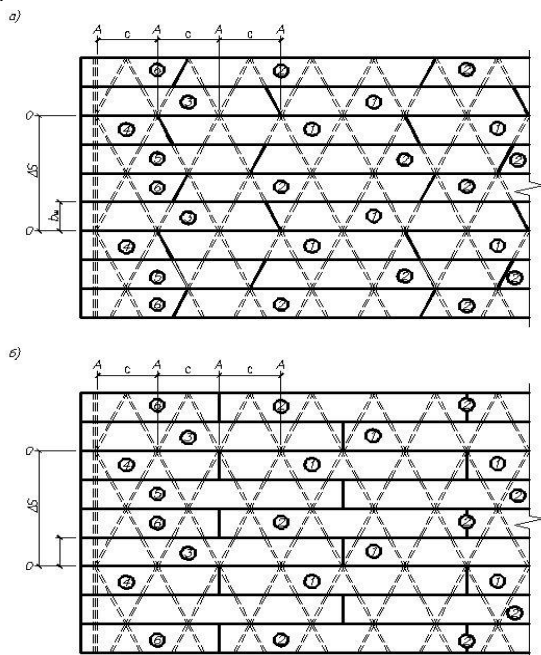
Развертка плана расположения кровельных клеефанерных щитов
